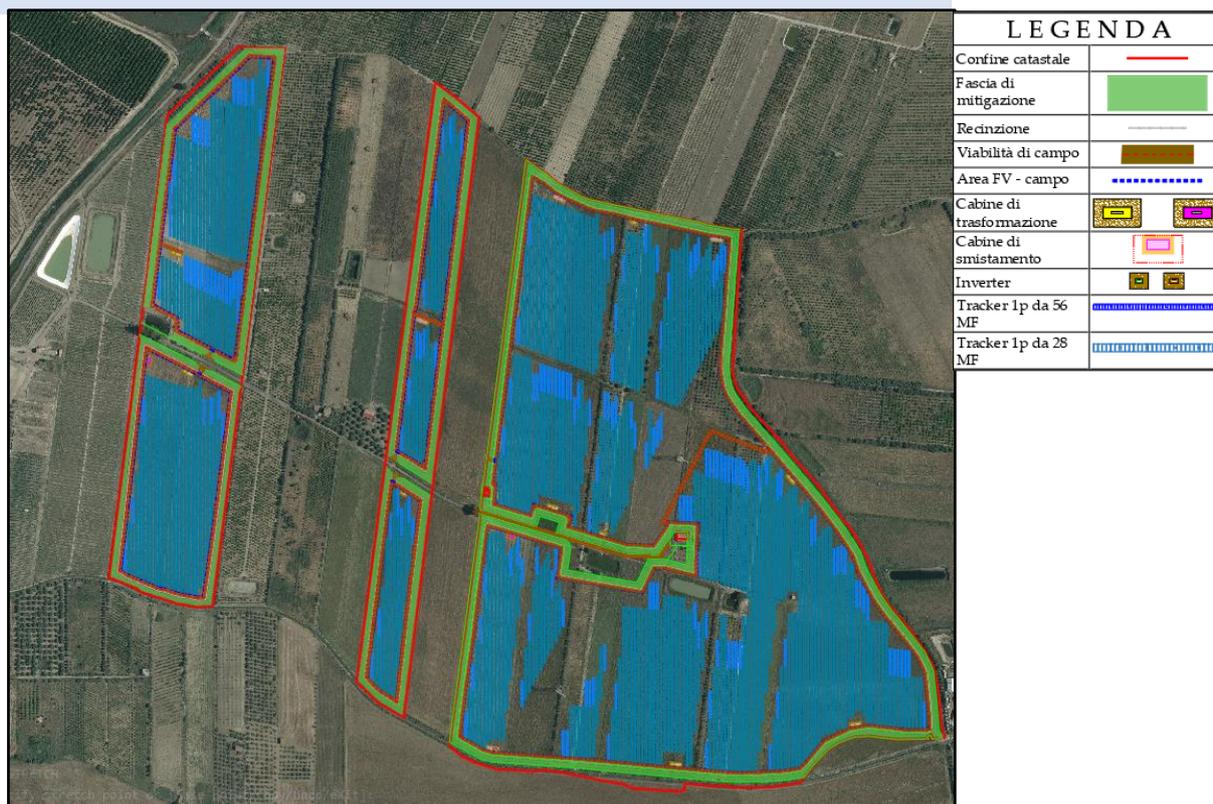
Stralcio tavola " 00\_PD.00 LAYOUT DI IMPIANTO SU ORTOFOTO".
